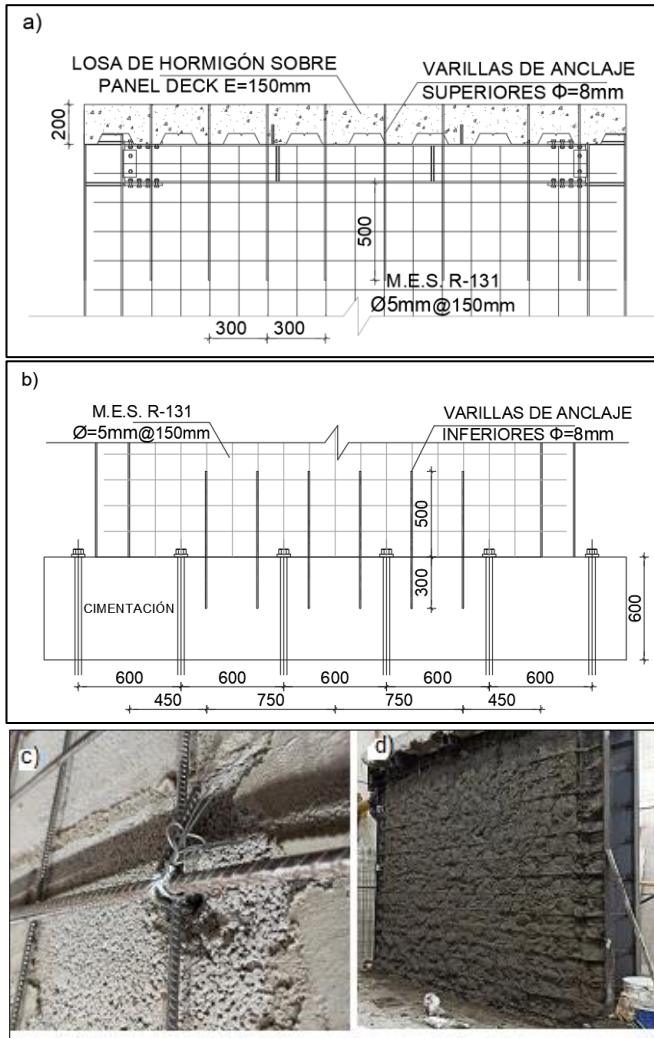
Esquemas de anclaje, a) Anclaje con losa de entrepiso, b) Anclaje de losa de cimentación, c) Anclaje de M.E.S. con mampostería, d) Enlucido con mortero. Dimensiones en mm
